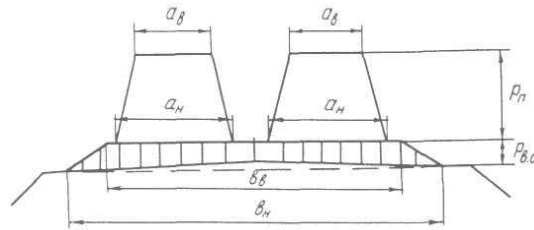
Епюри навантажень від верхньої будови колії і рухомого поїзда для двоколійного насипу
